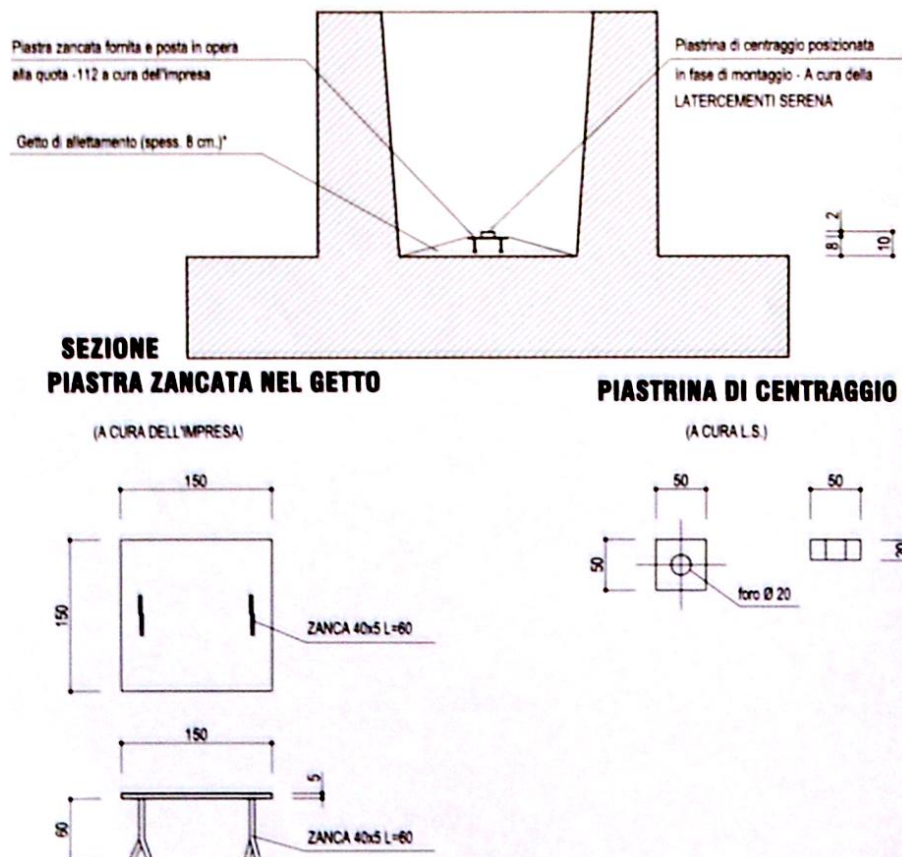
Particolare di A.2003.cap.us.T10 - Plinti di fondazione - Dispositivi di centraggio
